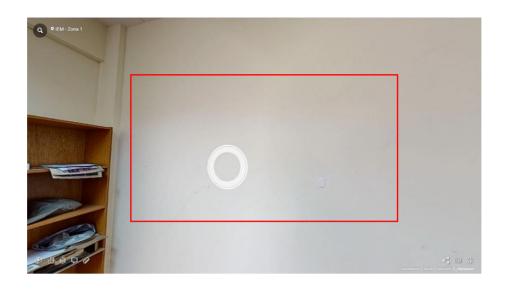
Sala de Reuniones (Fisuras)
